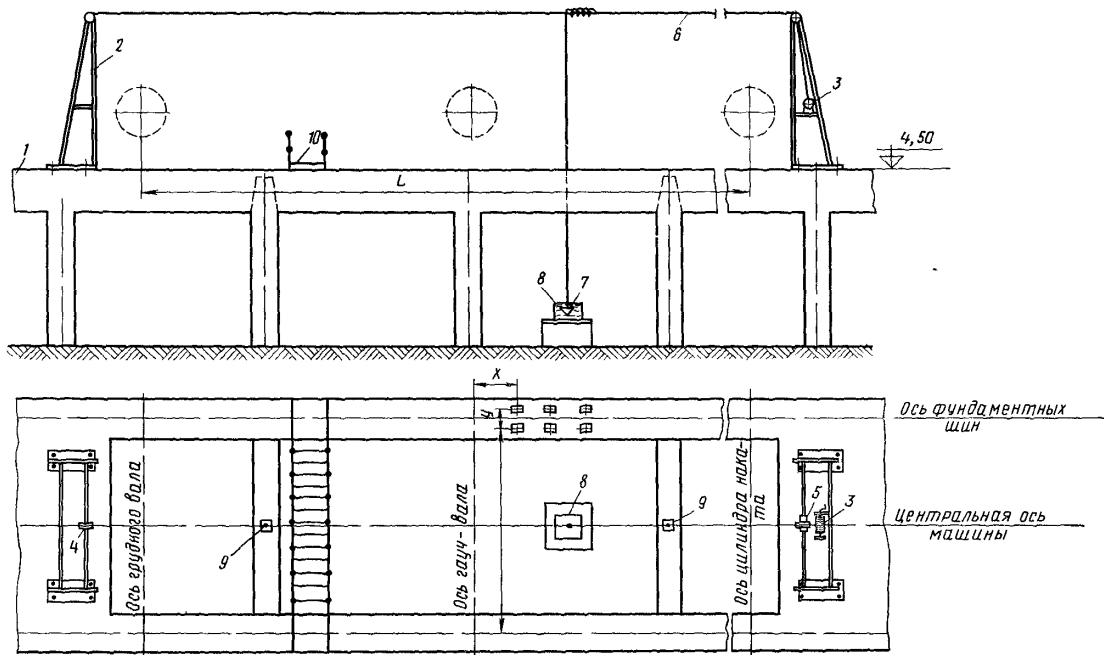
Схема приспособления для навешивания струны, фиксирующей центральную ось машины:
